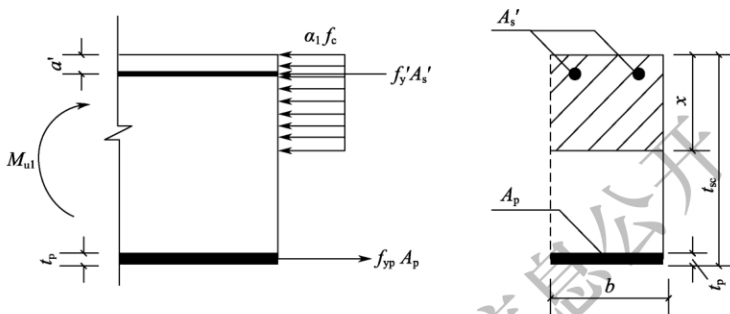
单钢板混凝土板正截面受弯承载力计算简图
